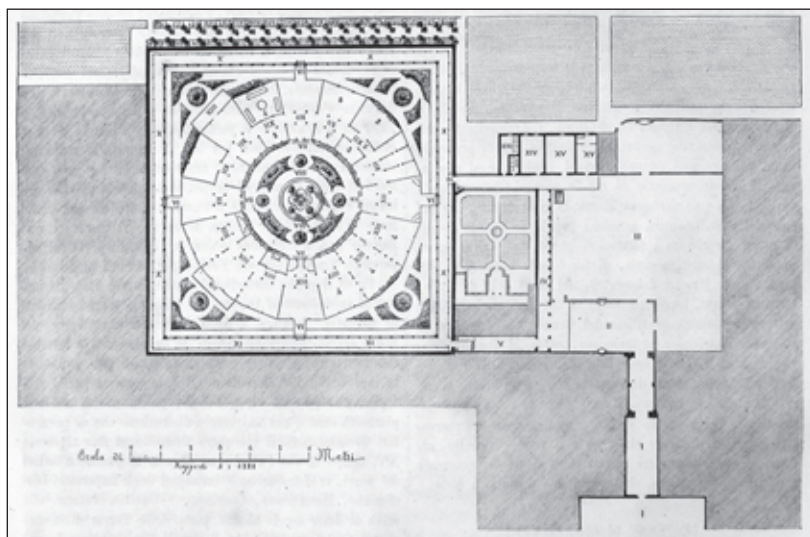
Pianta dell'Esposizione. "I. Primo ingresso ai locali ed uscita dei medesimi, II. Piazzale per la fermata delle vetture, III. Piazzale pel trattenimento delle stesse, IV. Guardaroba, V. Ingresso alle gallerie, VI. Passaggi dalle gallerie alle sale, VII. Passaggi dalle sale al giardino, VIII. Giardino, IX. Uscita dalle gallerie, X. Bracci della galleria per gli oggetti di Roma e di altre città, XI. Braccio riservato alla Commissione francese, XII. Sale per gli oggetti di Roma e di altre città, XIII. Sale riservate alla Commissione francese, XIV. Corpo di guardia dei Gendarmi, XV. Corpo di guardia dei Vigili, XVI e XVII. Cessi" (da *L'esposizione delle opere di ogni arte*, cit., p. 4)
